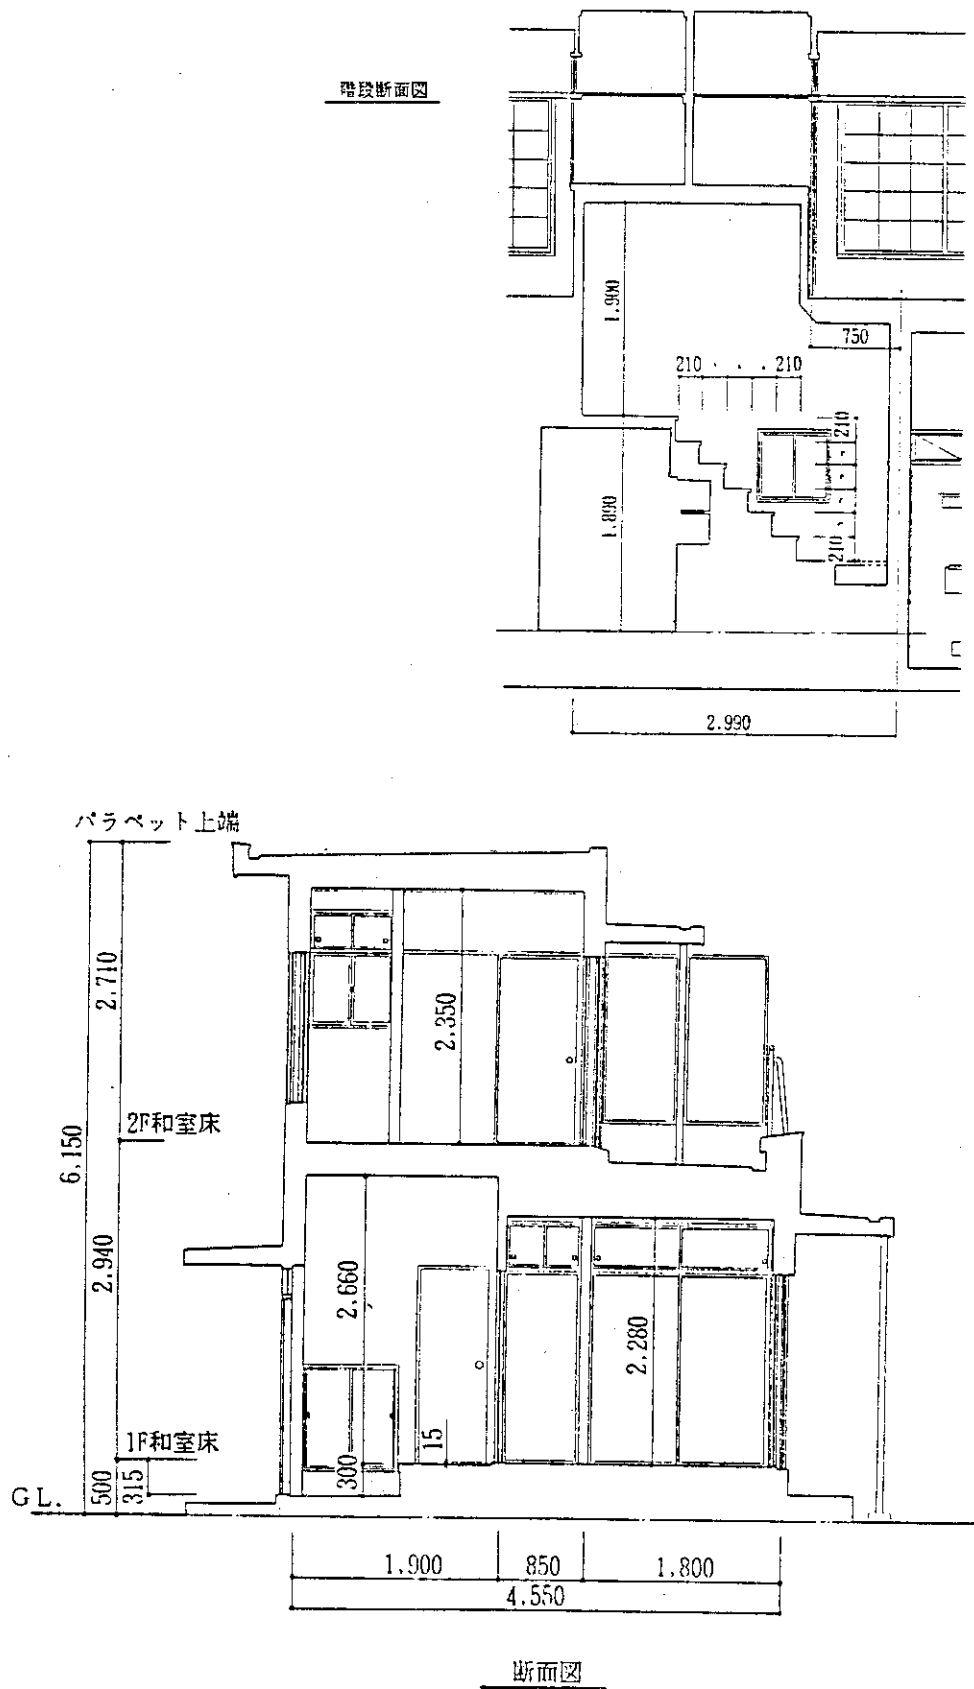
2 鉄筋コンクリートテラスハウスの断面図・階段断面図
